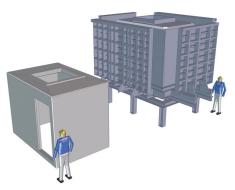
и 6: Форма и готовый туалетный блок из сборного железобетона
